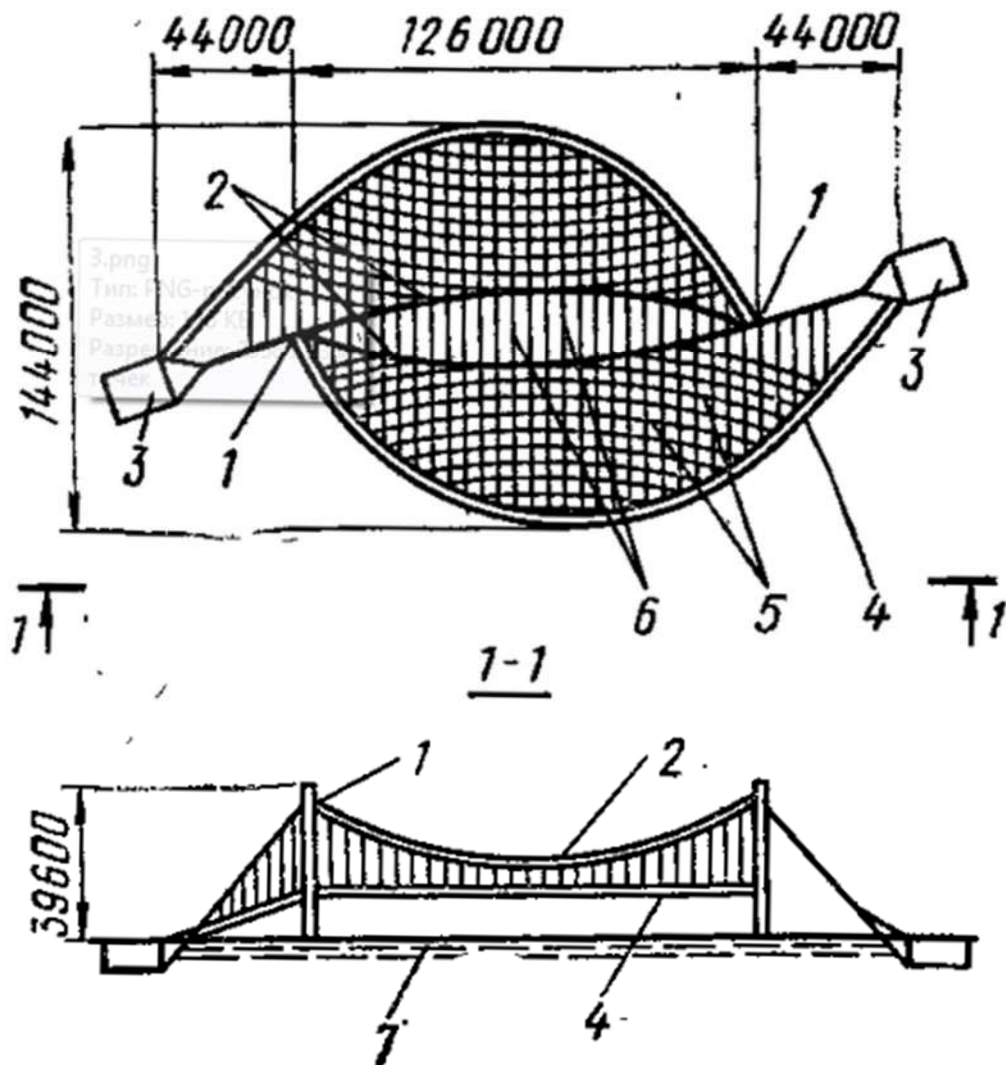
Пример сложного сетчатого покрытия плавательного бассейна олимпийского комплекса в Токио (Япония): 1 – пилоны; 2 – тросы подборы; 3 – анкерные фундаменты; 4 – контурные балки; 5 – вантовые фермы; 6 – связи; 7 – распорные балки
